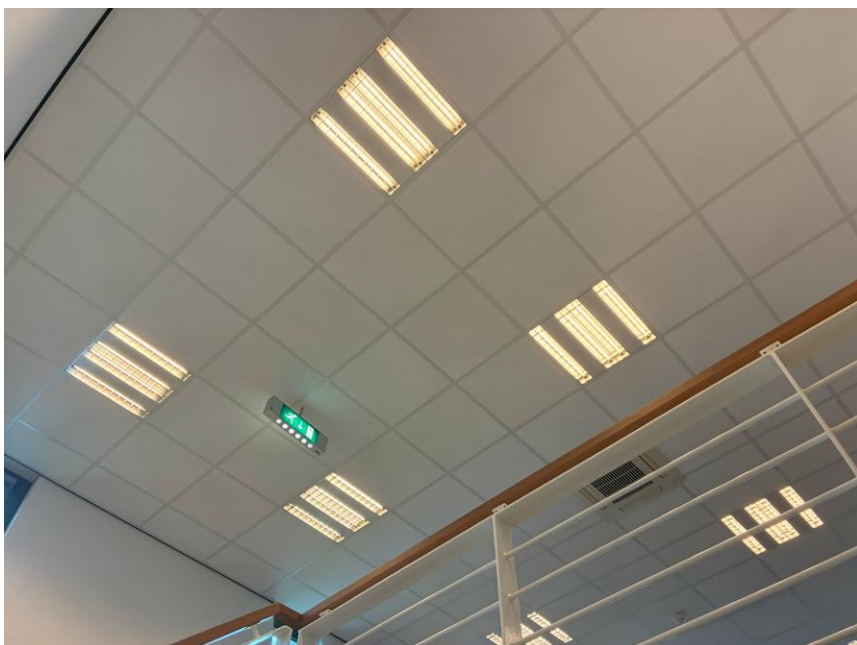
Overzichtsfoto van verlichtingstype G in kantoren voorzijde Gemeentewerf Waalwijk
